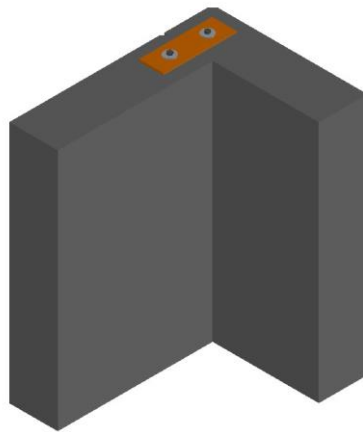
Pormenor de fixação entre painéis (José Rui Pinto, 2021)
